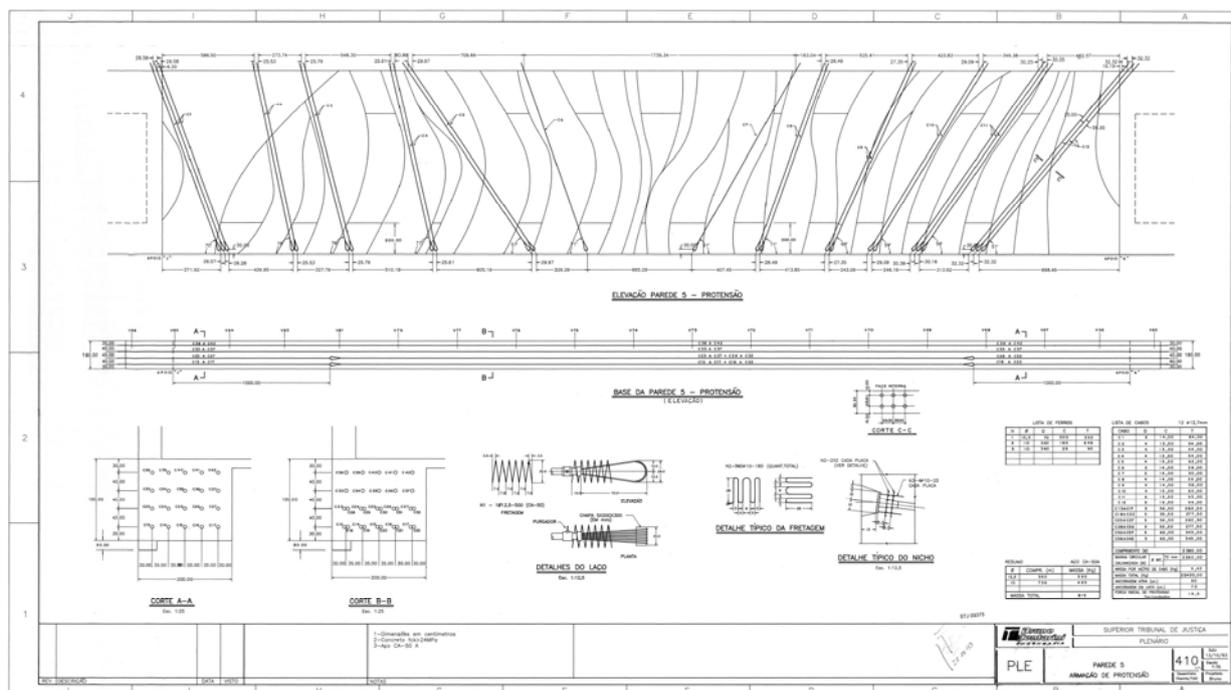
Projeto da armação das cordoalhas de protensão da viga-parede 05. Fonte: Coordenadoria de engenharia do STJ.
